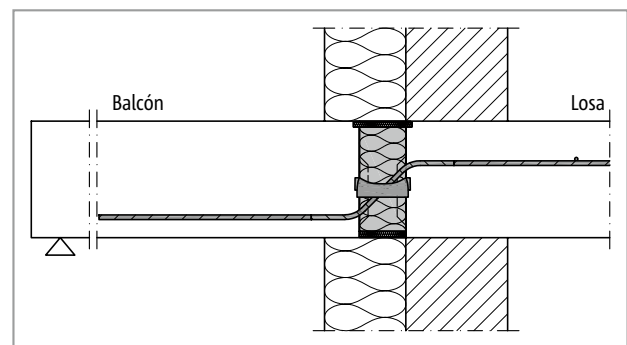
Schöck Isokorb® T tipo Q: Conexión para sistema de aislamiento térmico exterior (SATE) (p. ej., T tipo Q-V6 hasta Q-V12)
